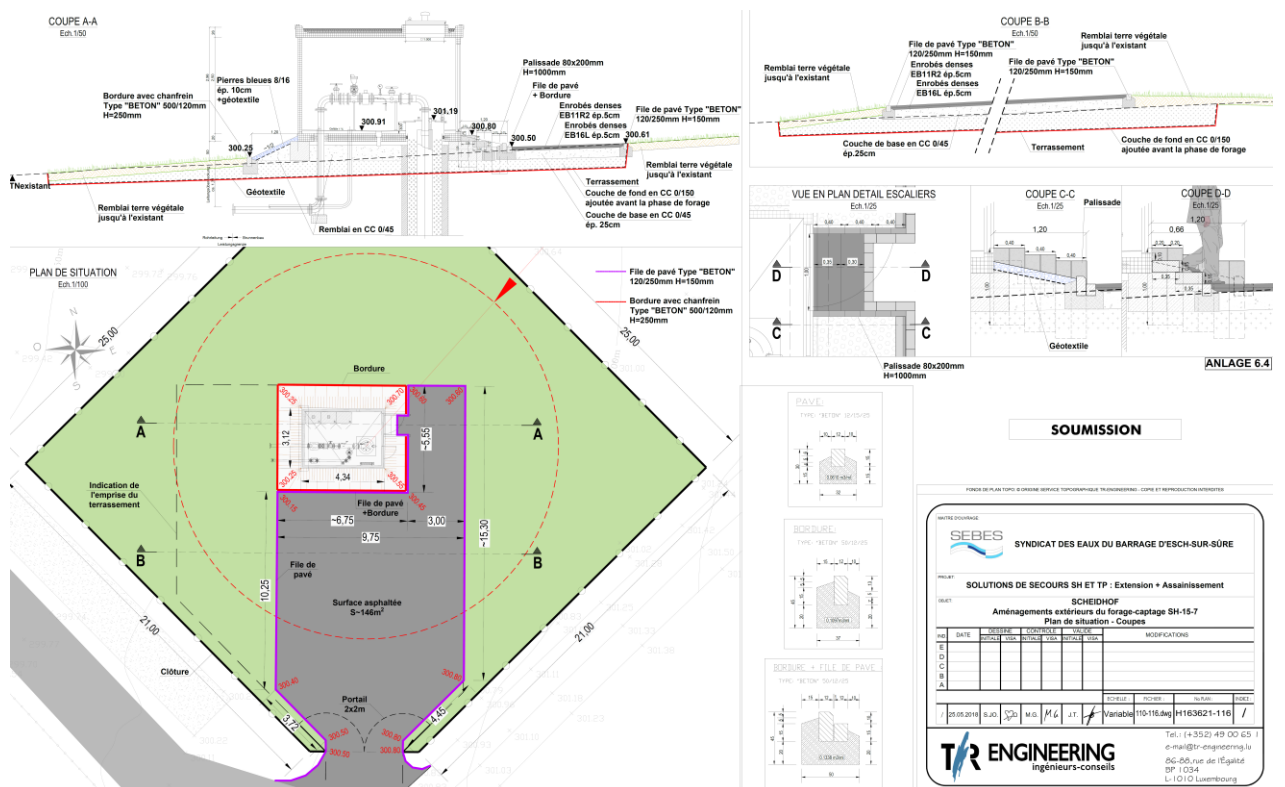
Plan de situation für die Außenanlagen des Brunnens SH 15-7. Quelle: TR-Engineering, 2019
